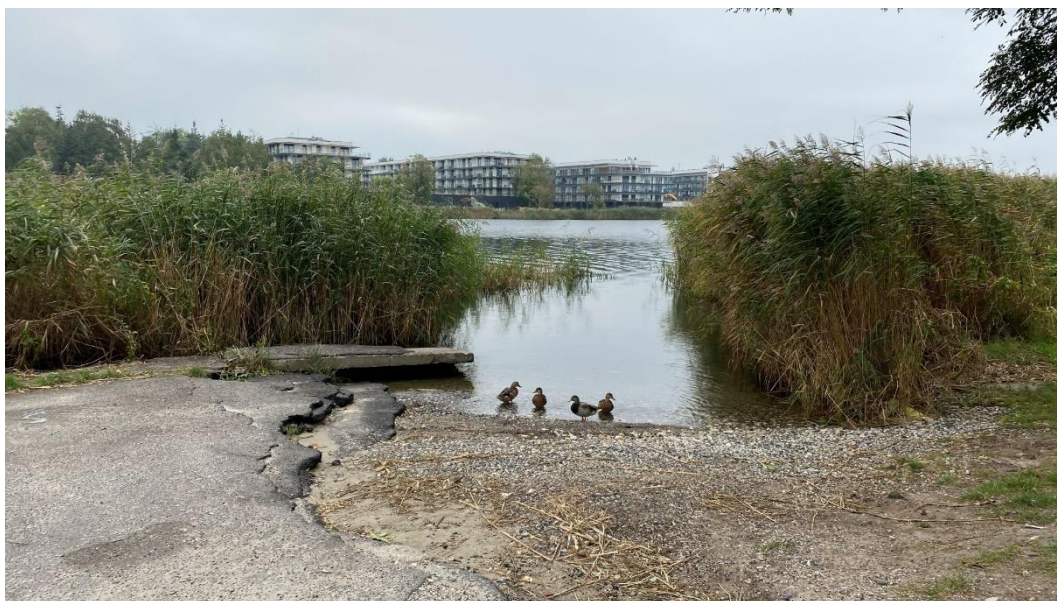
Wschodnia część terenu inwestycji – widok w kierunku zachodnim
